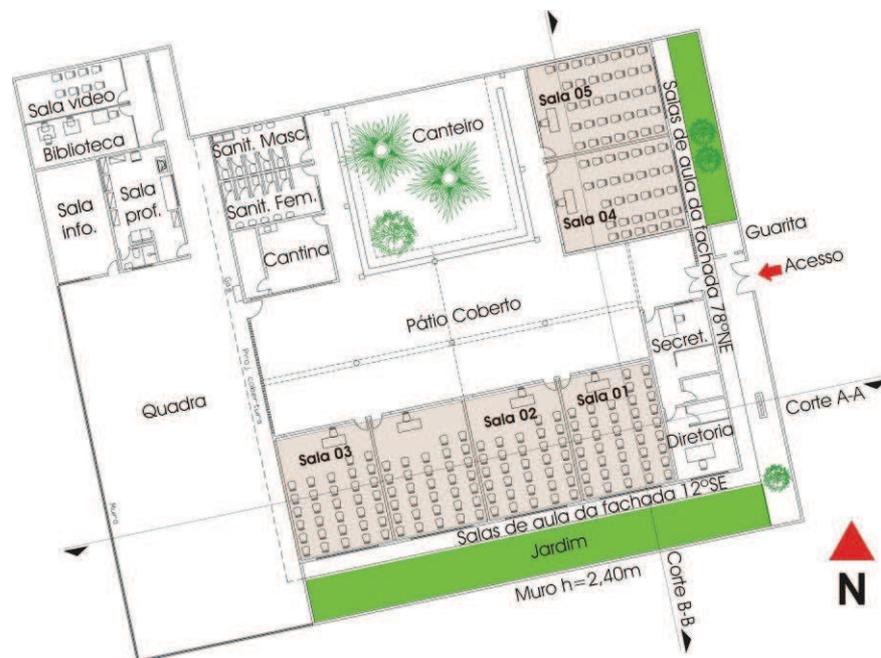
Planta baixa da escola indicando acesso e localização das salas de aula.
